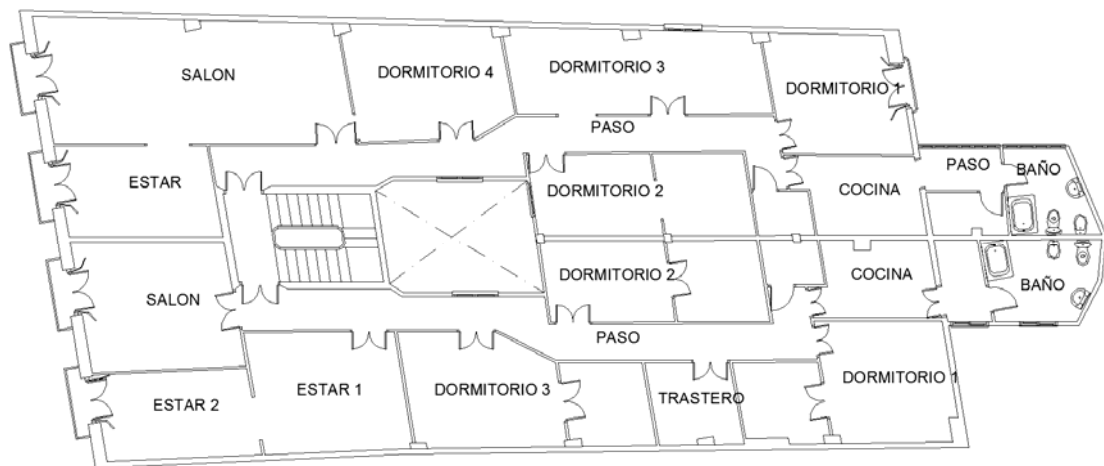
Plano de Planta de un edificio residencial de tipo "popular sencillo", con dos viviendas por planta
